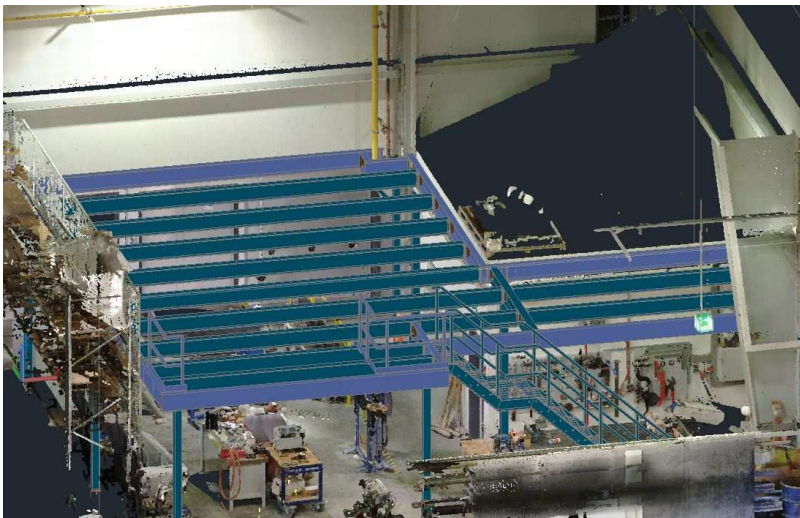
Übersicht Punktwolke mit Stahlbau Planung
